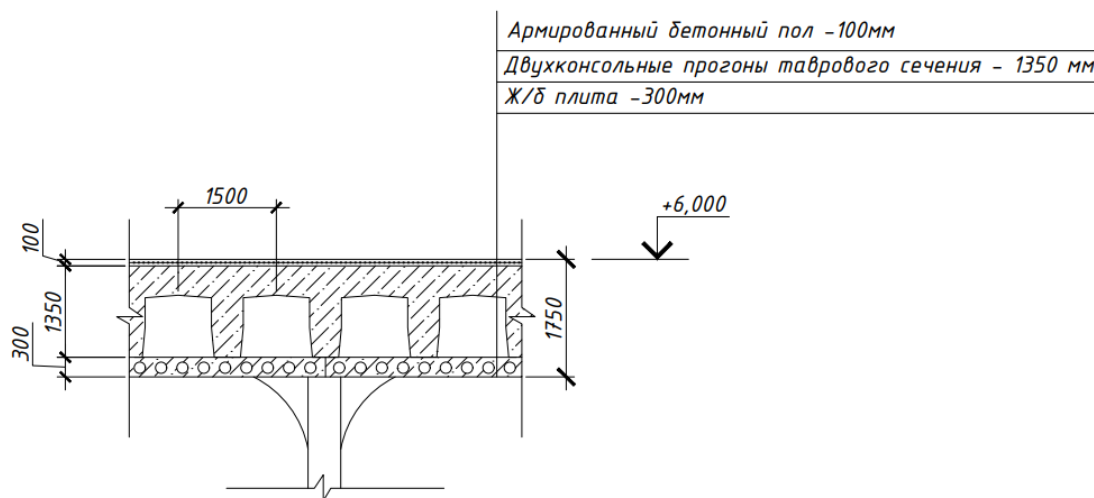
Узел перекрытия железнодорожной платформы (Чертеж автора).
